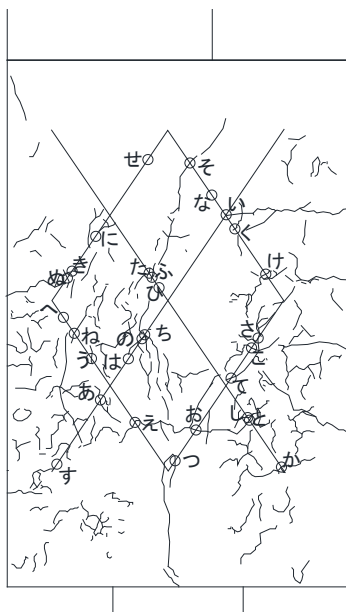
パイルキャップひび割れ幅測定位置 (試験体 C-3 正載荷)
